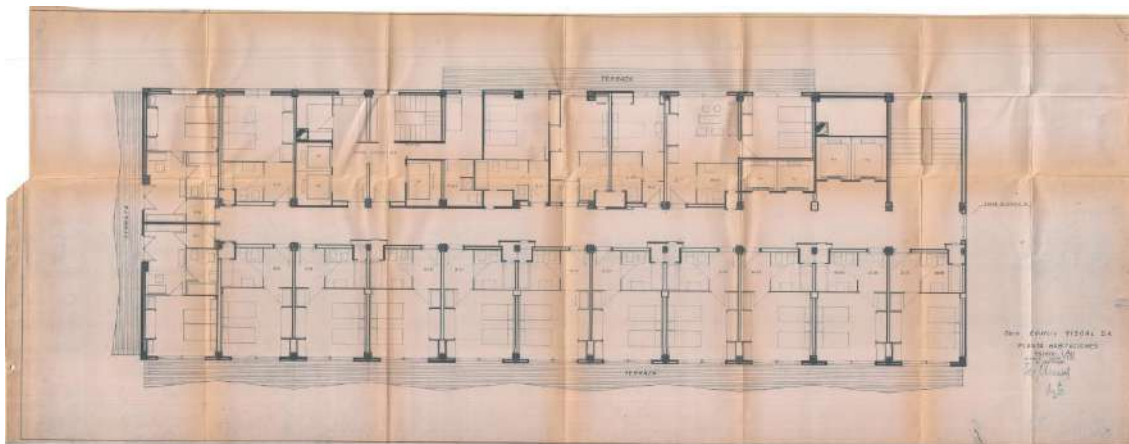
Plano de planta tipo de habitaciones. Fuente: Muñoz, 1963
